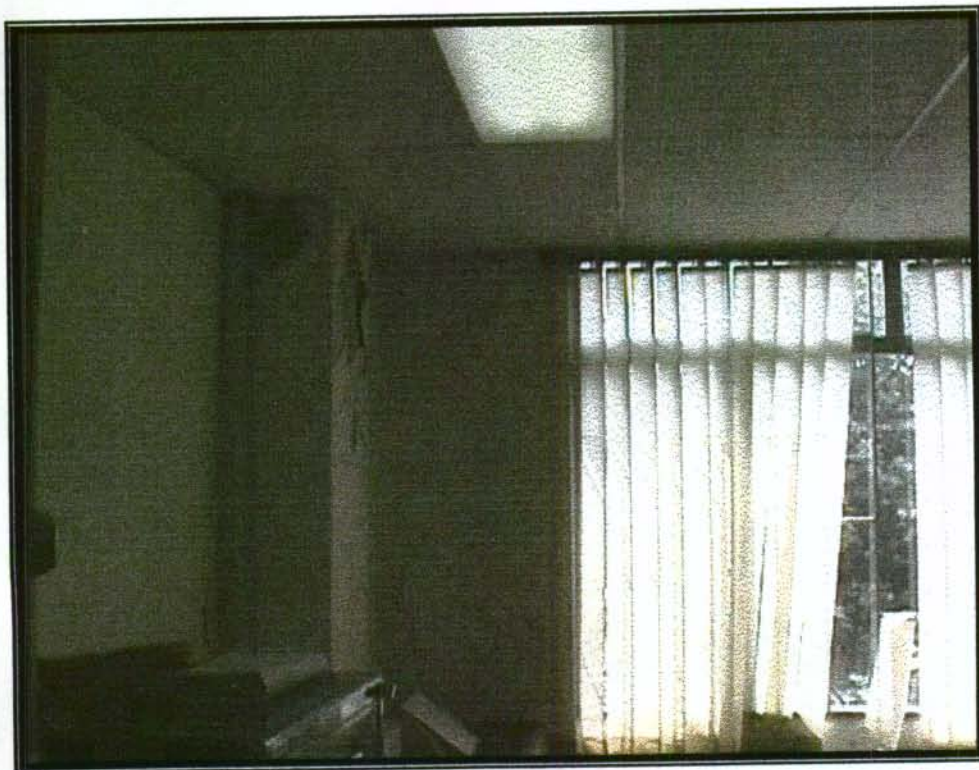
DETERIORO EN COLUMNA A NIVEL DE CUBIERTA ZONA DE PORTICOS DE CONCRETO
